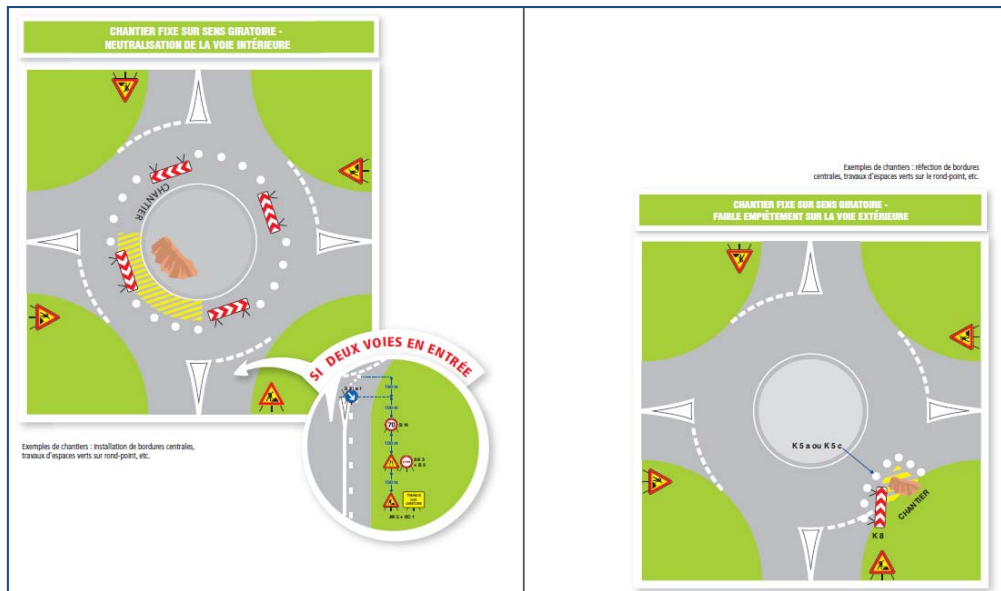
Exemple de signalisation temporaire d'un chantier fixe sur sens giratoire
